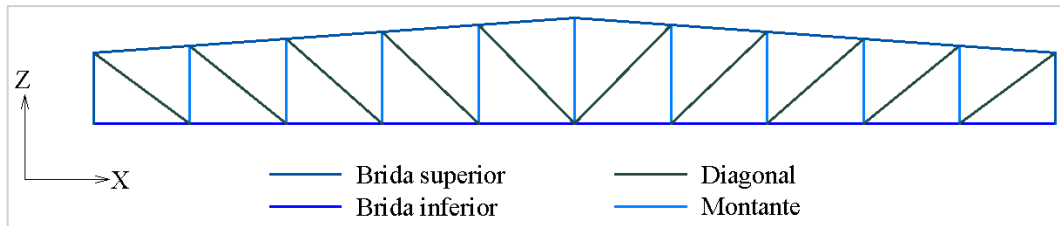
13. Disposición de los elementos estructurales en armadura.
